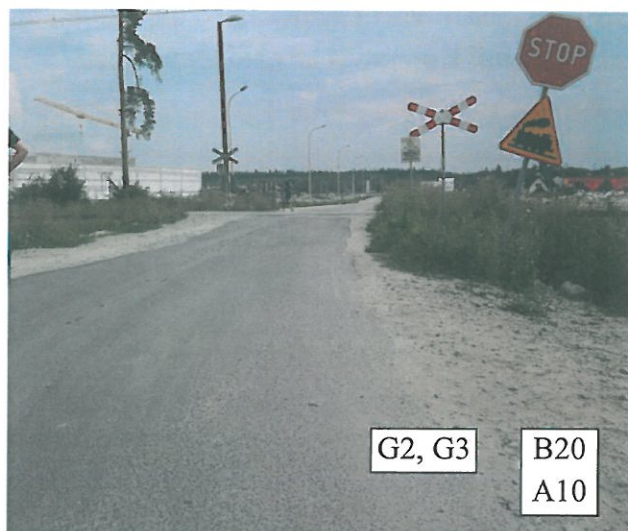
Widok przejazdu z kierunku zbliżającego się samochodu
